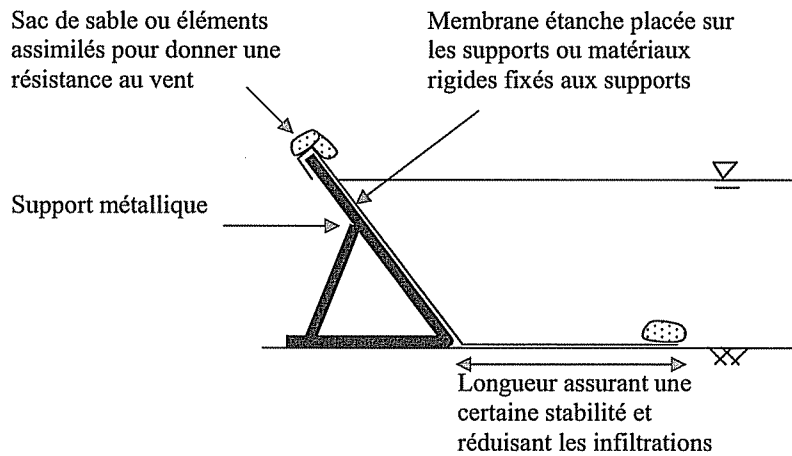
Schématisation (coupe en travers) d'un batardeau composé d'une structure servant de support et dont l'étanchéité est réalisée par un matériau de couverture
